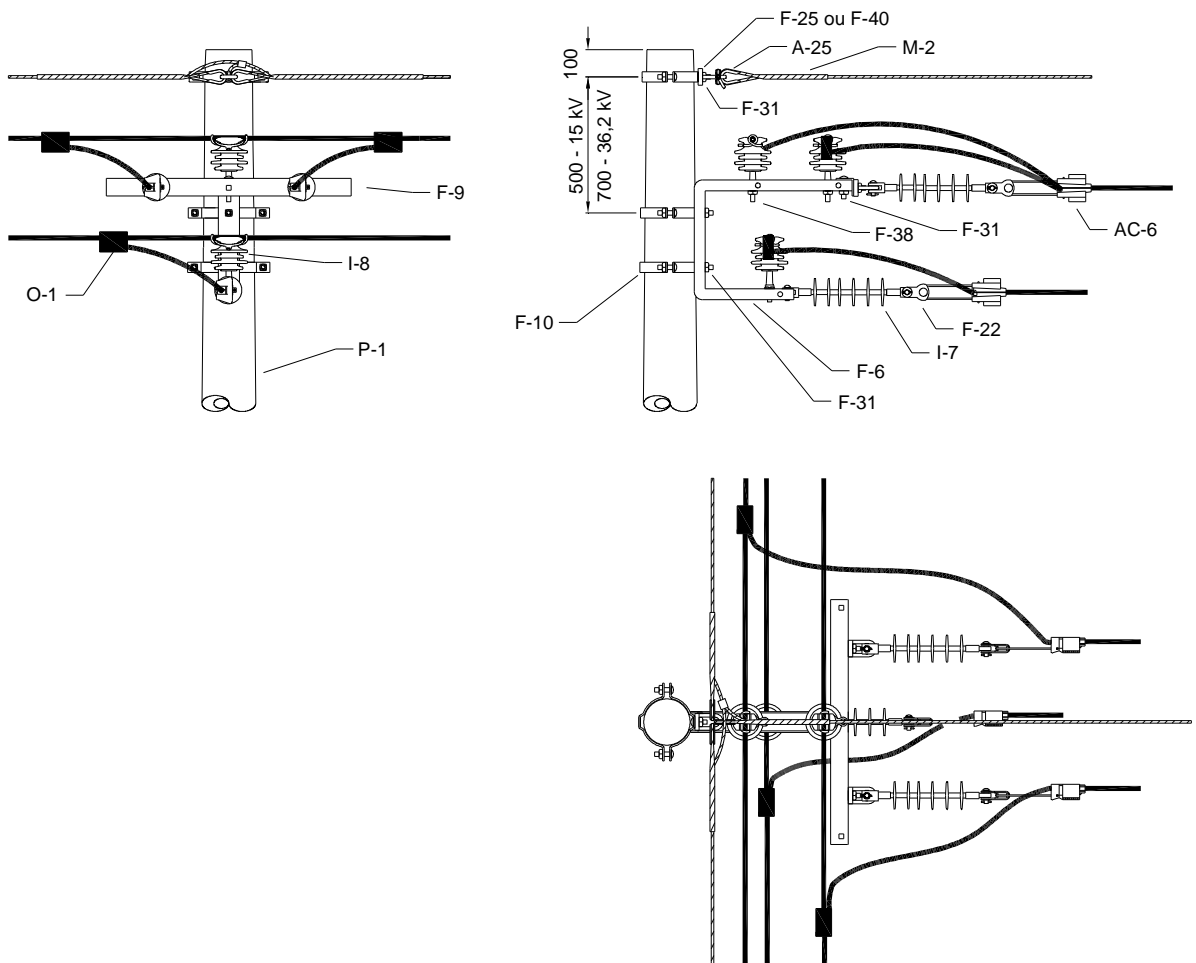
Estrutura CE3-CE3-PU – Poste de Concreto de seção DT
